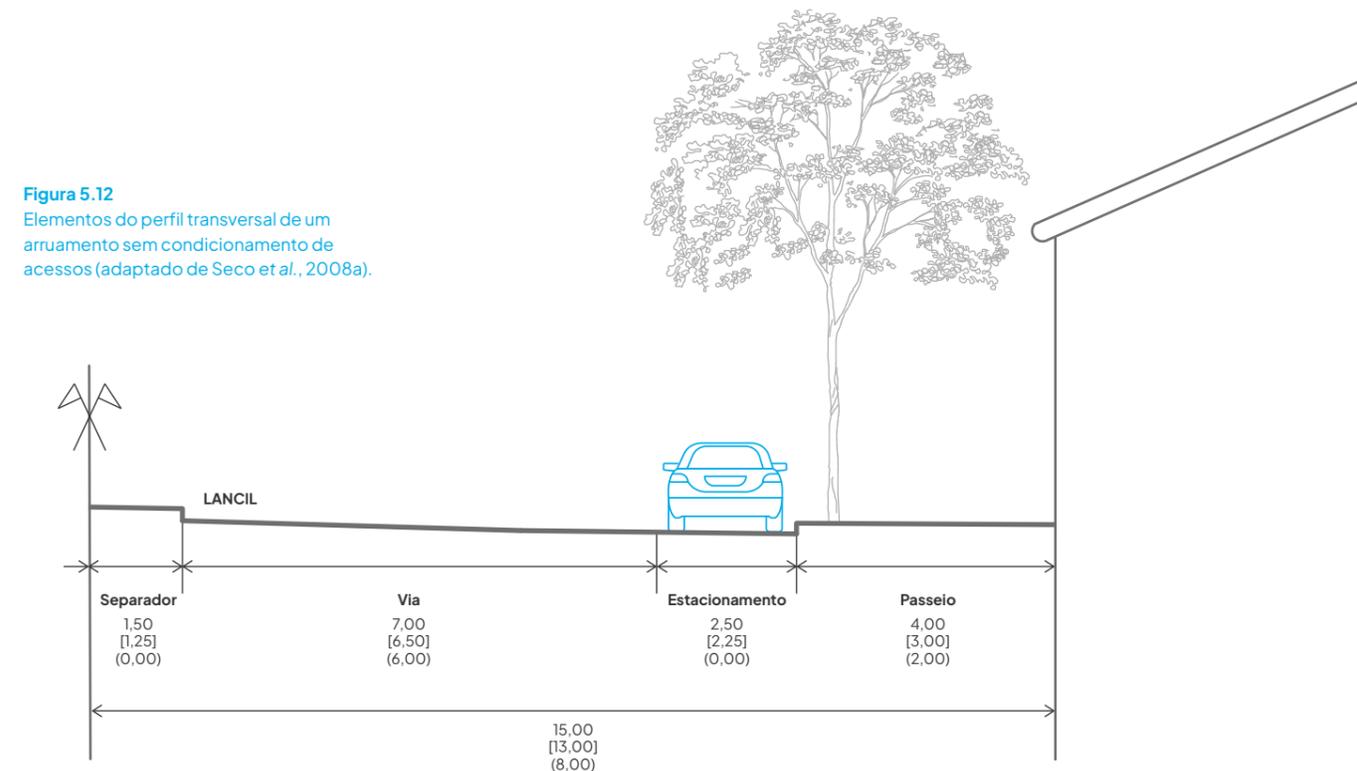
Elementos do perfil transversal de um arruamento sem condicionamento de acessos (adaptado de Seco et al., 2008a).
